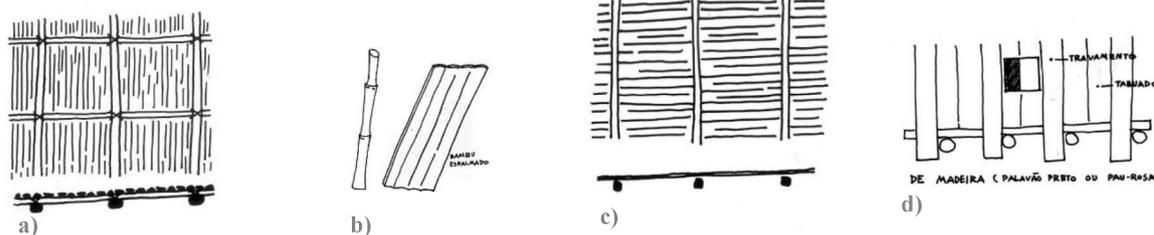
12. Paredes. a) Parede de palapa b) Cana de bambu aberto c) Parede de Bambu espalmado d) Parede de madeira de eucalipto.
